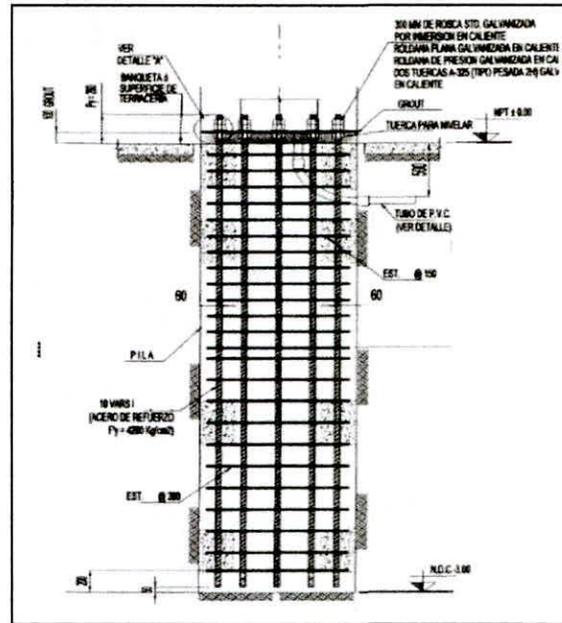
Cimentación poste de 12 a 20 metros
